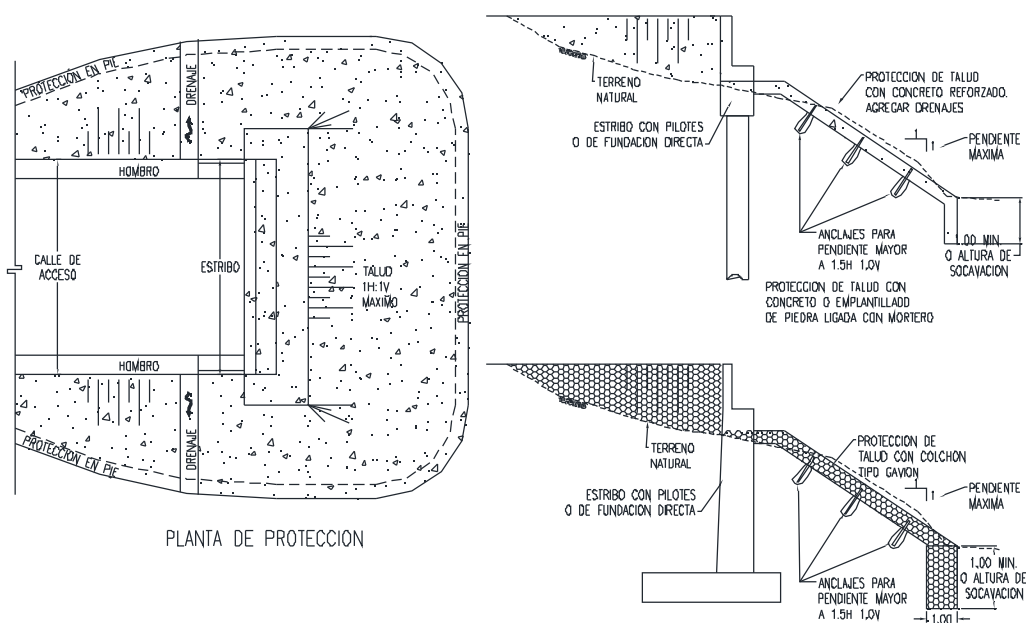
Protección para estribos sin muros en las márgenes del río, con andajes. (SPOP, 2014)
